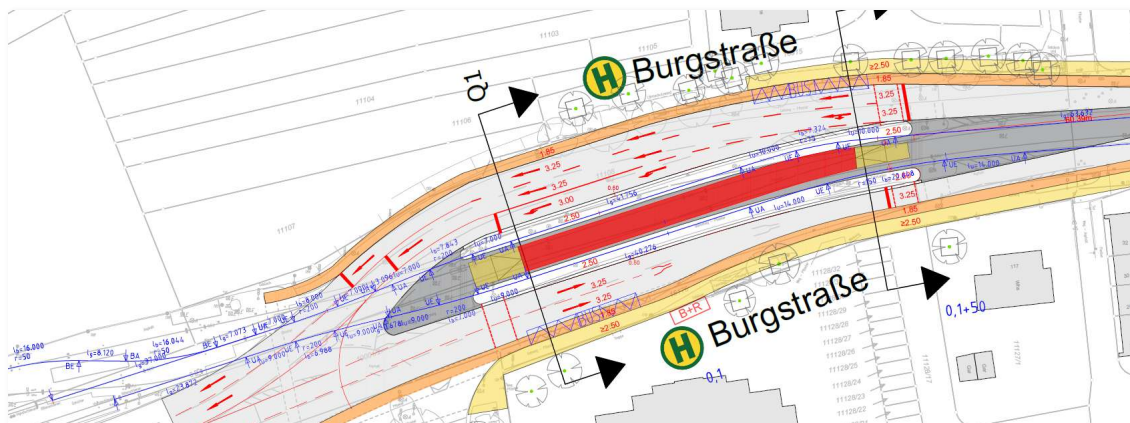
Lageplanausschnitt Haltestelle Burgstraße mit Mittelbahnsteig
